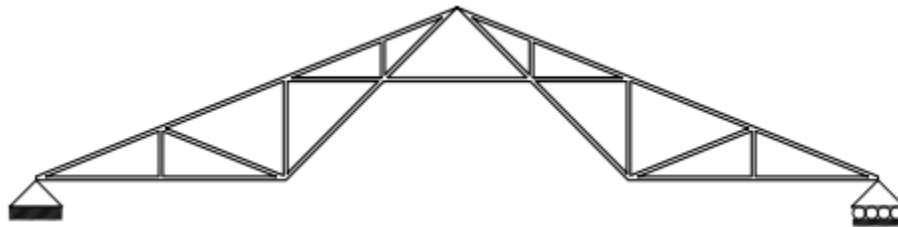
Variante 1 de armadura de cubierta tipo tijera
